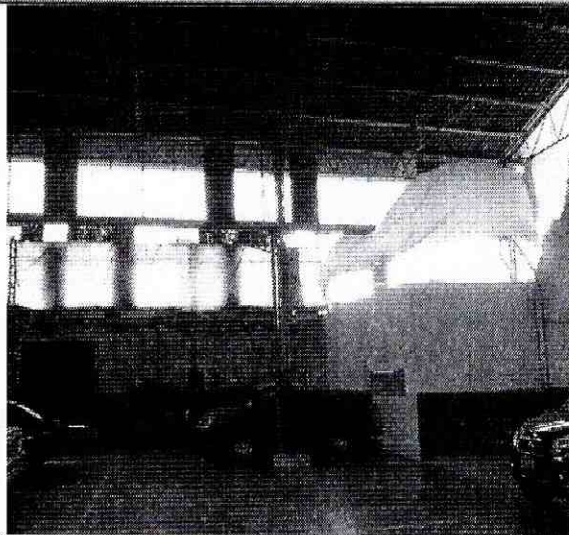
y 2. Se observa edificación estructura metálica cubierta en asbesto cemento, piso en concreto y mampostería en bloque de arcilla.
